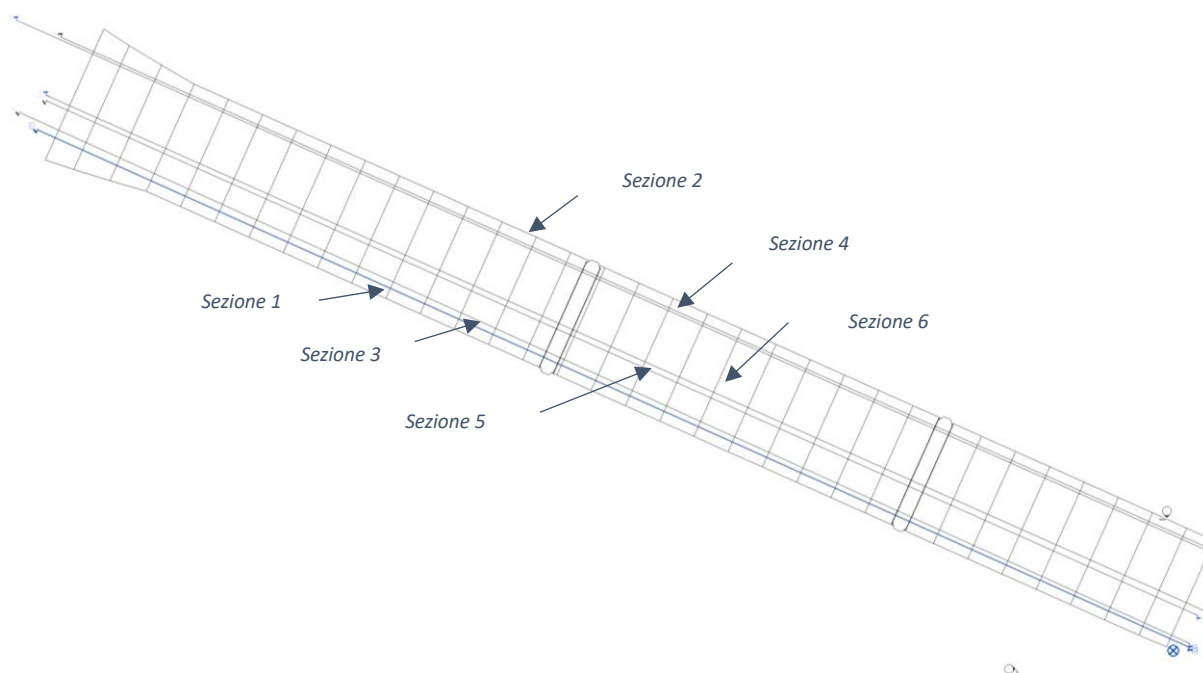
Definizione dei piani di sezione nella vista in pianta.
